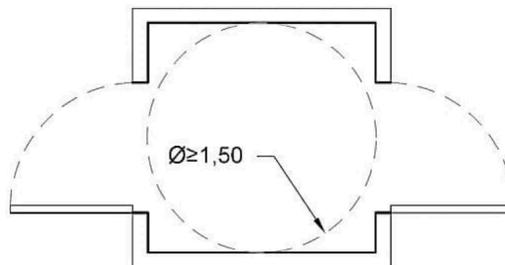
4. Vestíbulo previo con apertura de puertas hacia el exterior
